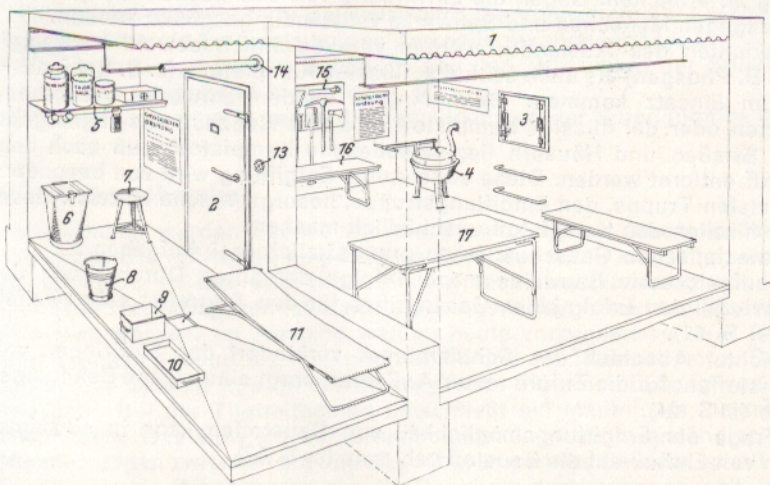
Der Baustoff Stahl im Schutzraumbau. Links Gasschleuse, rechts Schutzraum. Das Bild zeigt die vielfache Verwendung von Stahl bei den Bauteilen und Einrichtungsgegenständen des Schutzraumes.
